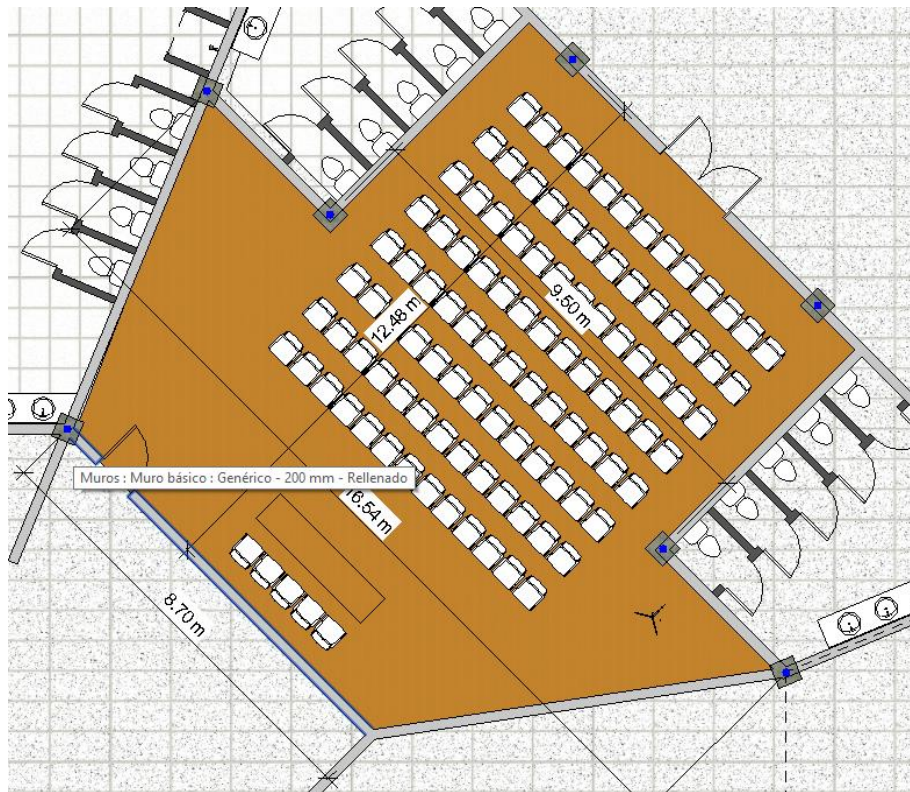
Vista en planta de la sala de conferencias. Fuente: elaboración propia.
